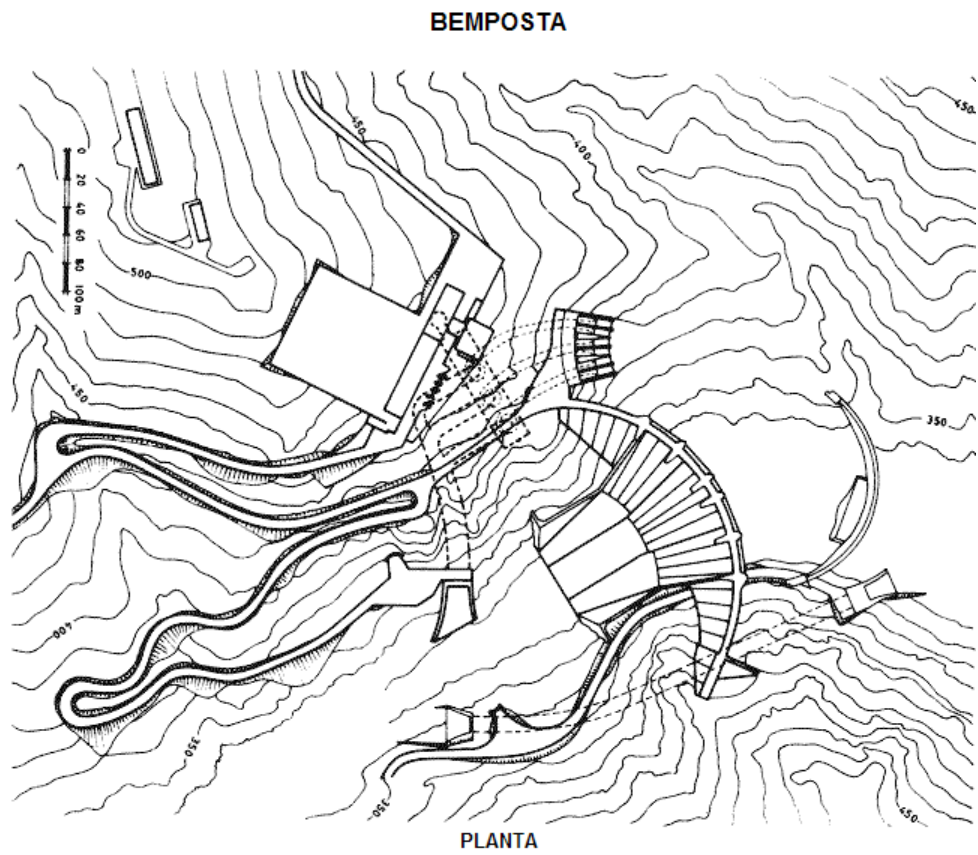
Barragem de Bemposta – Planta [4]
